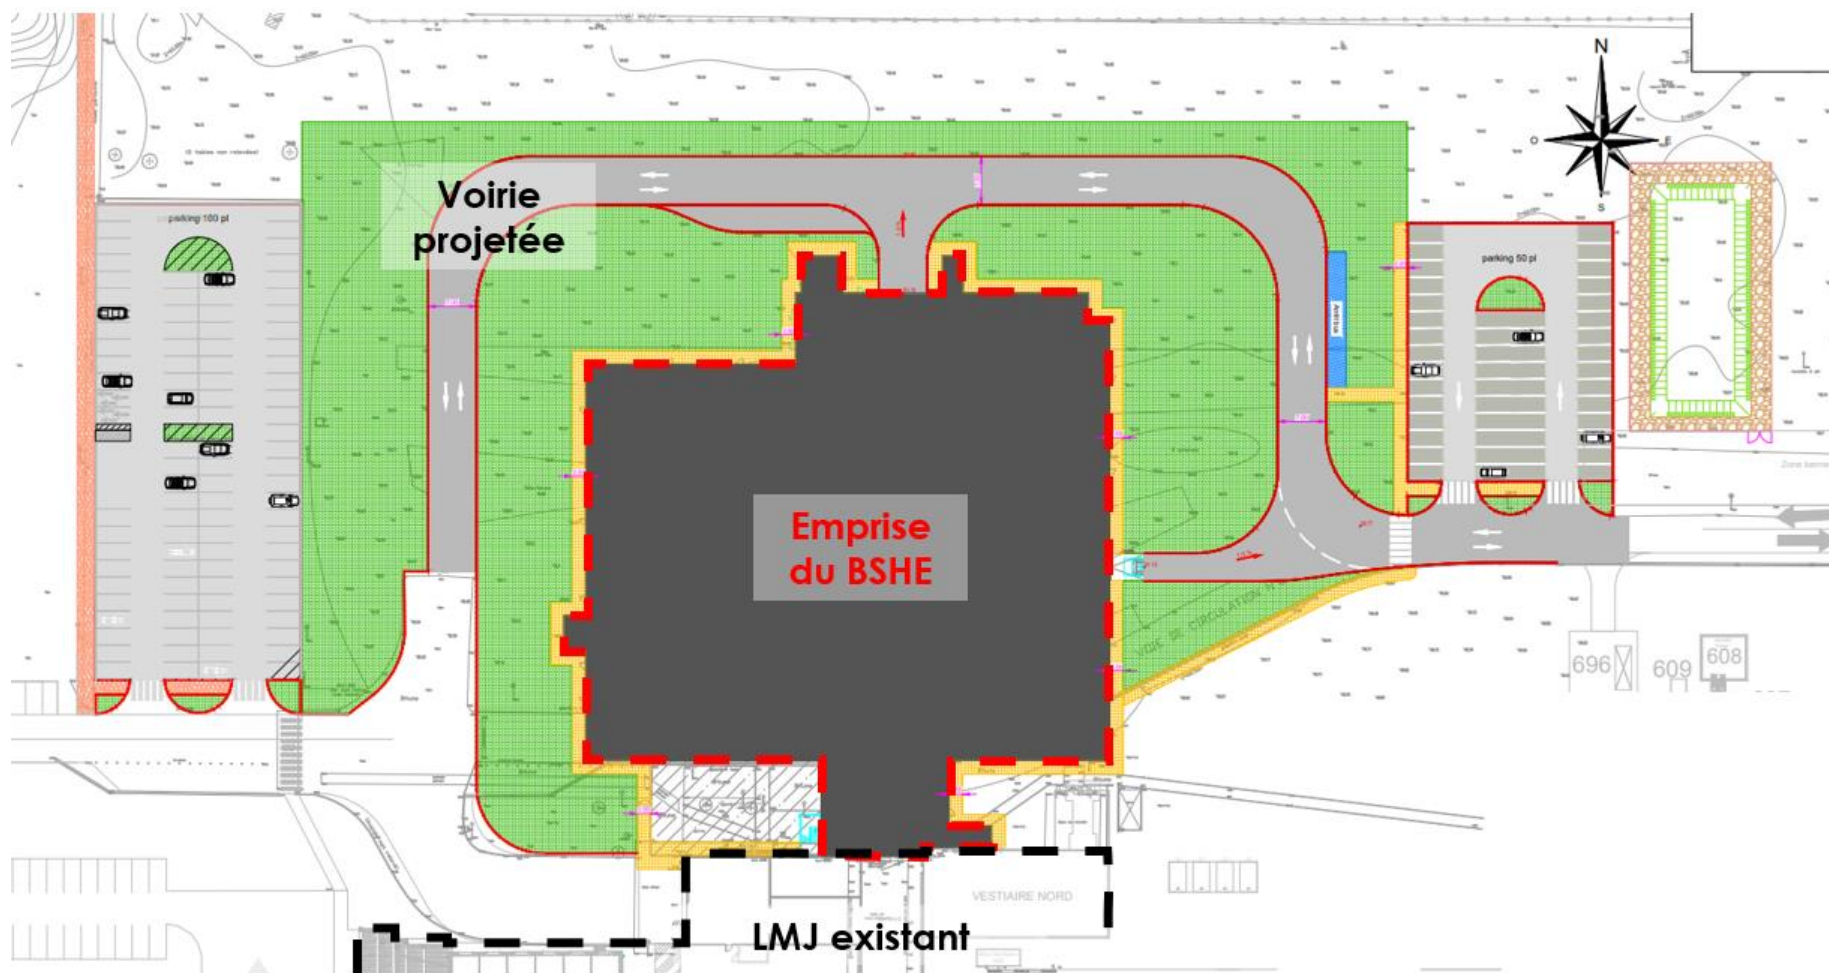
Plan de masse du projet – CEA – Sans échelle
